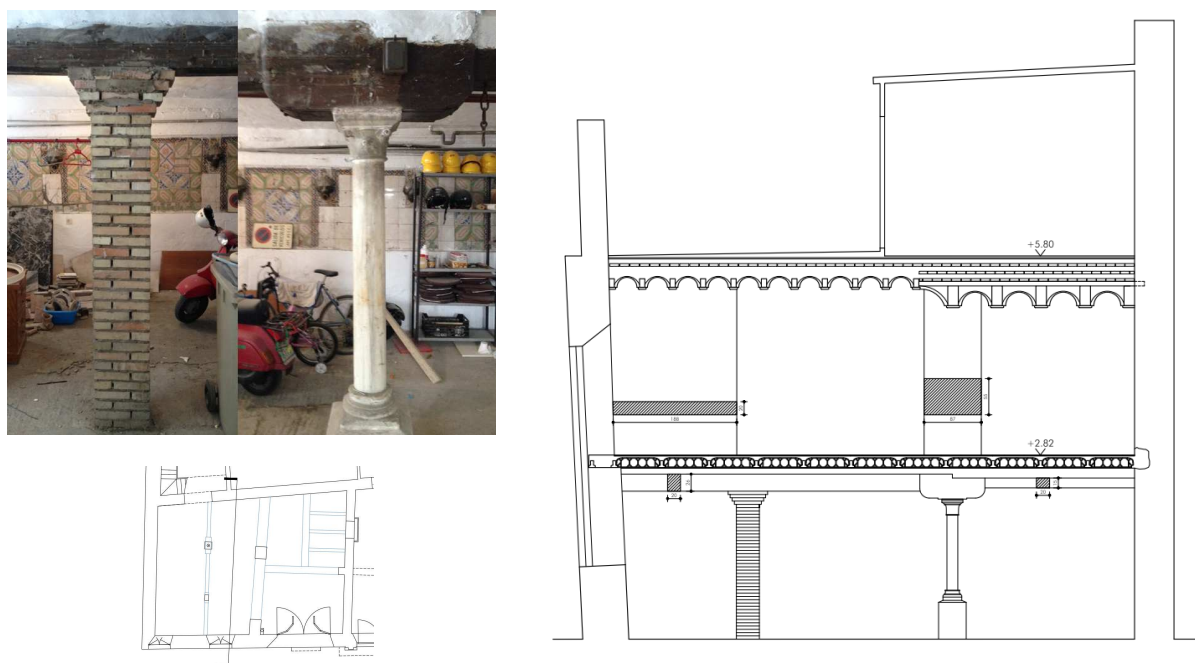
Línea de soportes de apoyo de la entreplanta y forjado +5,80 m, entre muro medianero (OM) y muro 1M.
